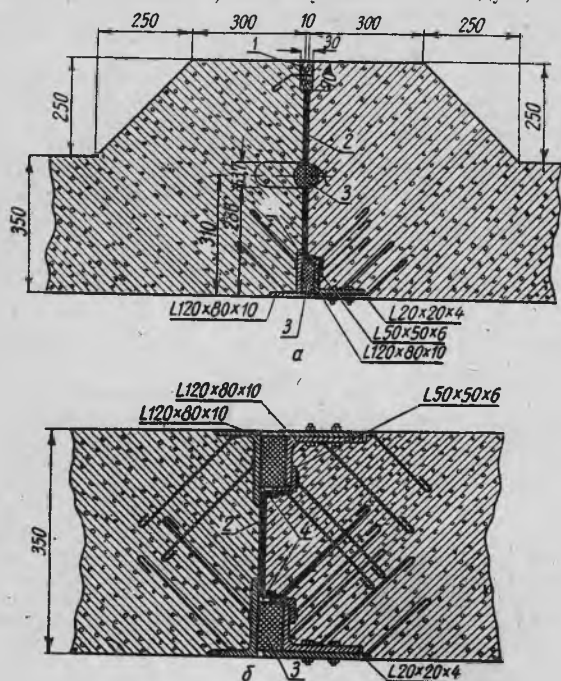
Конструкция швов в стыках напорного монолитного железобетонного прямоугольного двухочкового трубопровода:
